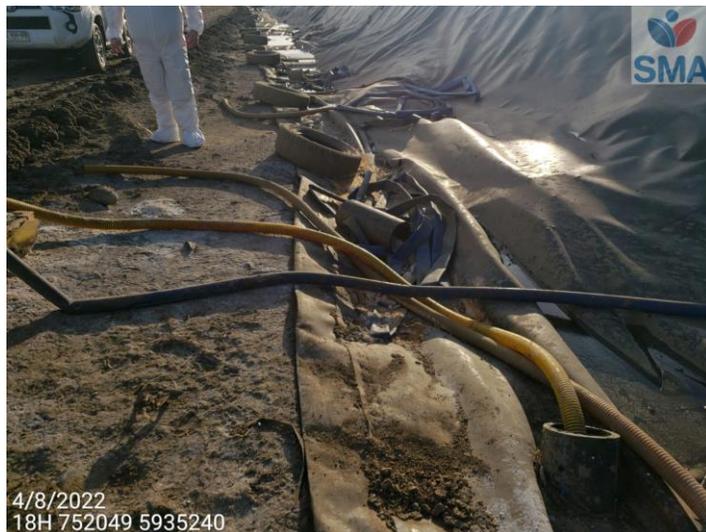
Estación 3 Vista cobertura superficial UAL 2 - RSU
